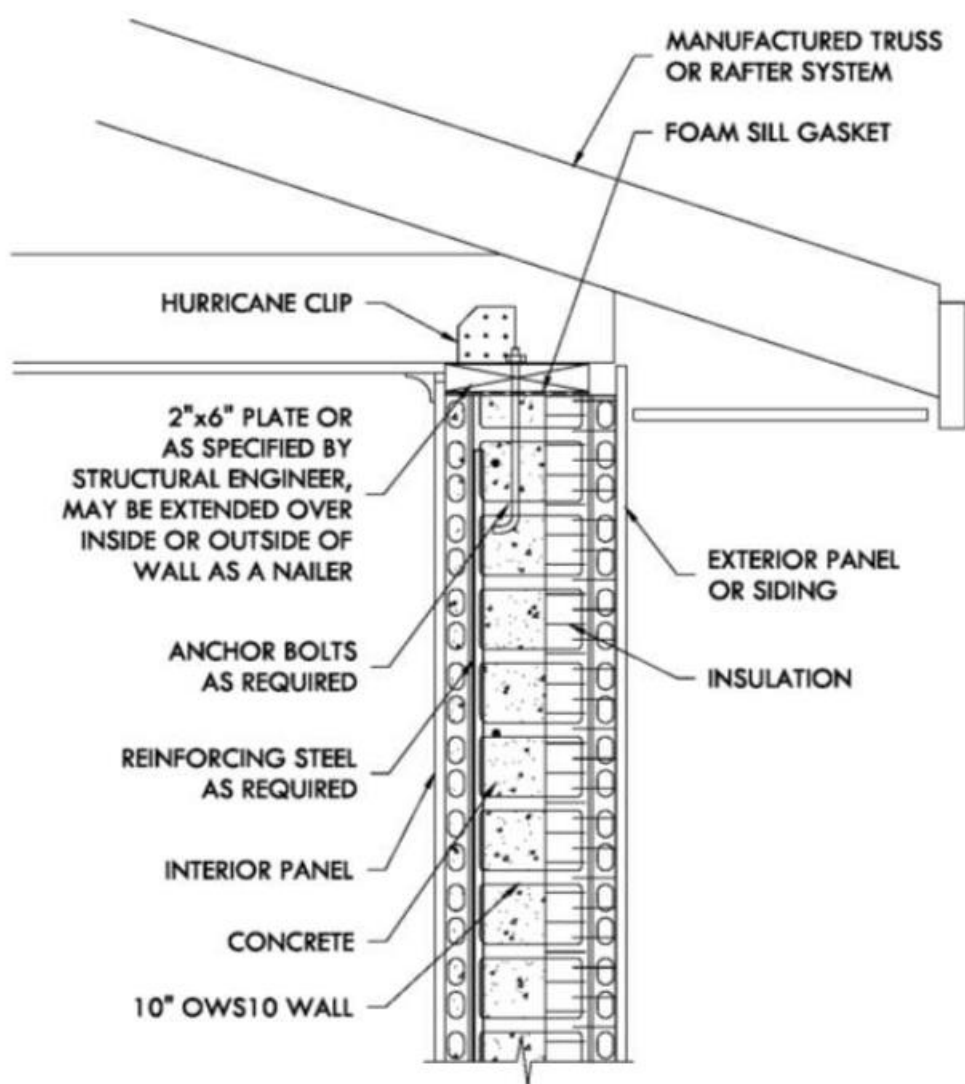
Detalhe da ligação da parede com vigas de cobertura madeira
